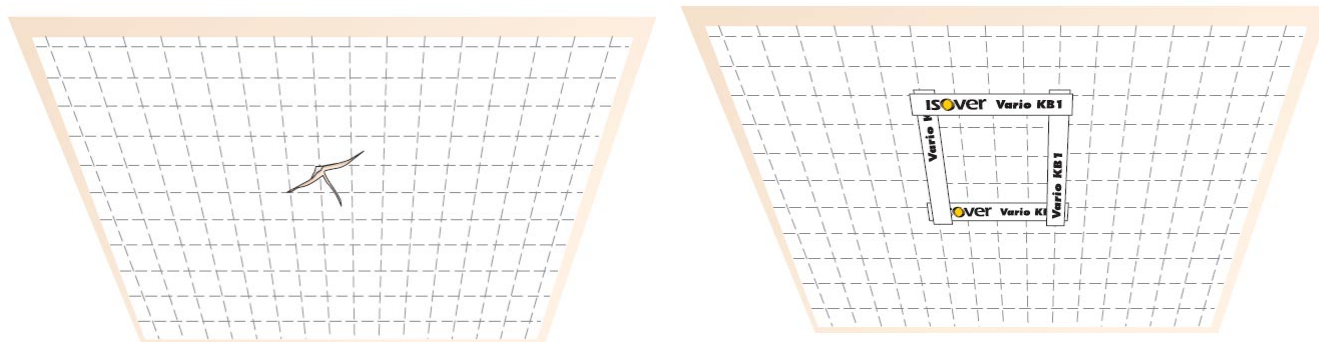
Réparation d'une déchirure ou entaille de grande dimension
